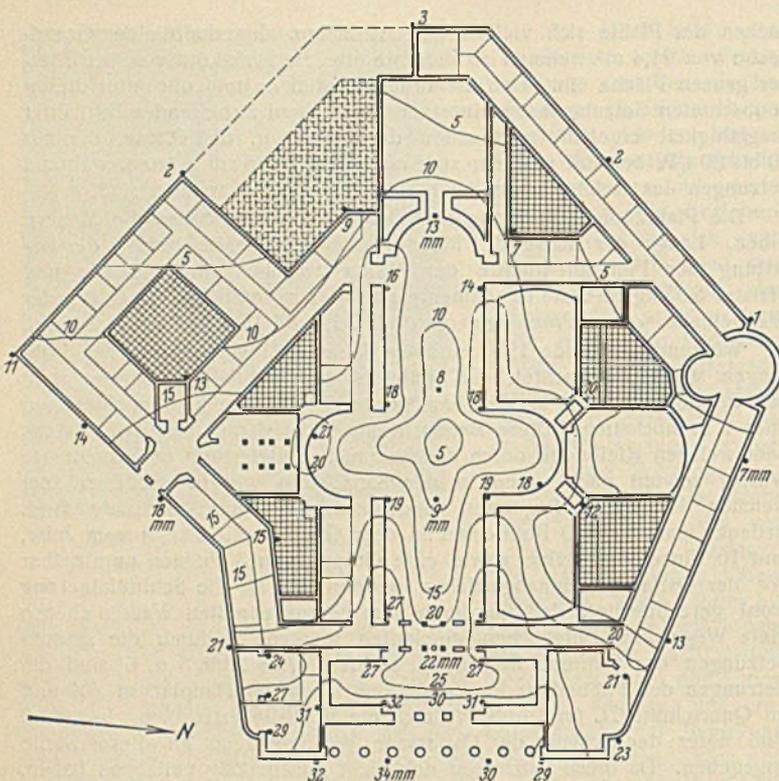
Kurven gleicher Setzungen im Erdgeschoß.
